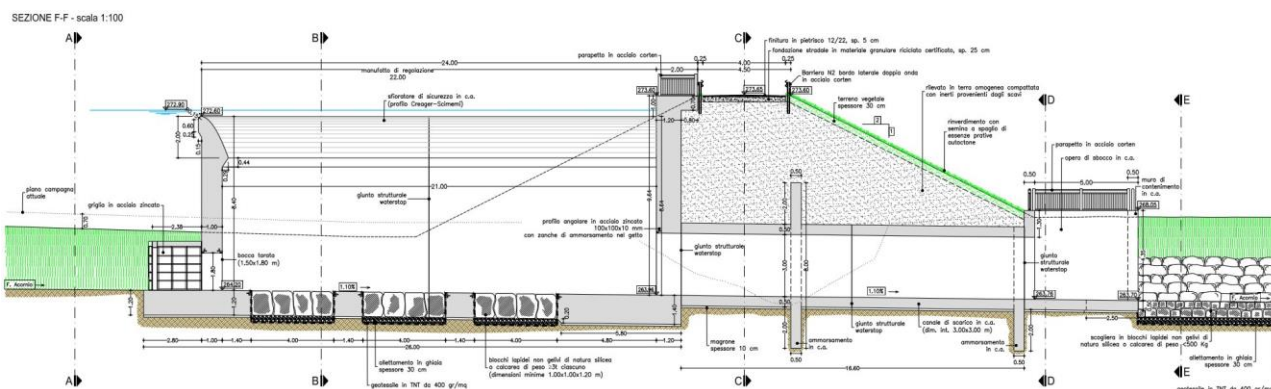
Sezione longitudinale di dettaglio del manufatto di regolazione e scarico in c.a.
